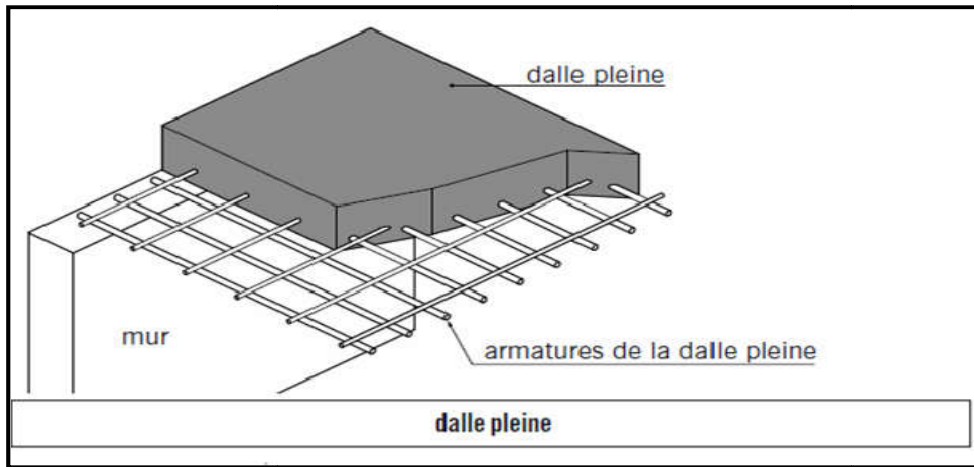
éléments d'un Plancher en dalle pleine.
